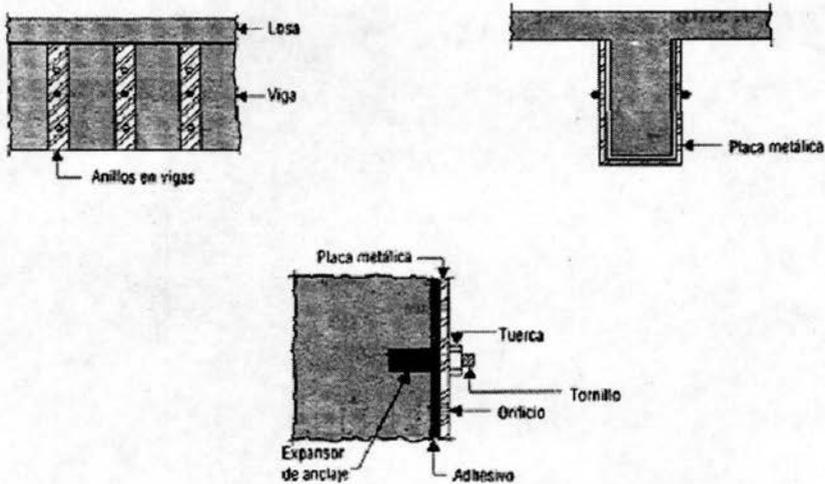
Refuerzos - Cortante. Placas metálicas adheridas con resina epóxica
